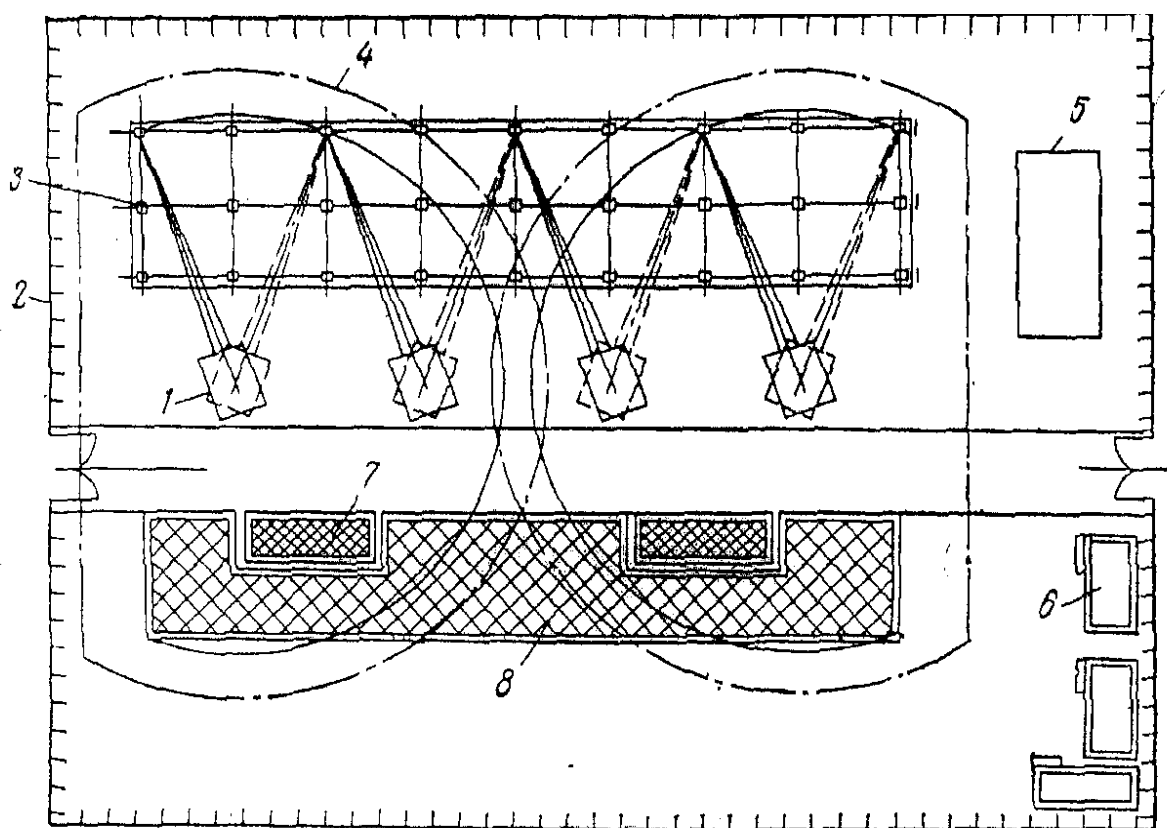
Схема установки стреловых самоходных кранов на строительной площадке:
